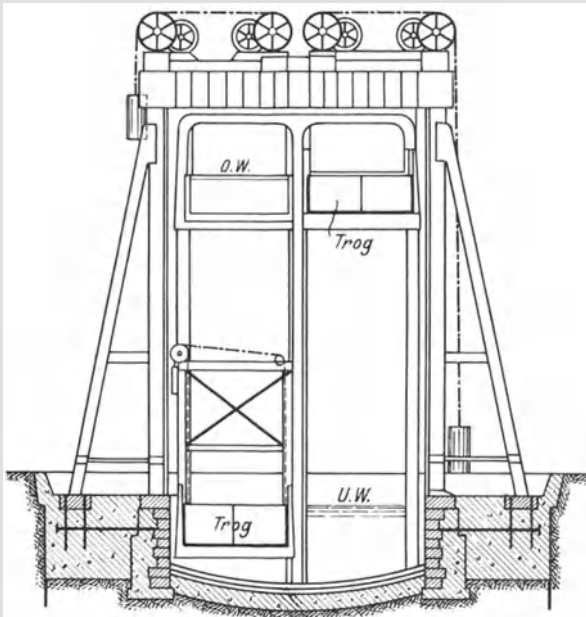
Hebewerk Anderton, England, nach Umbau.
